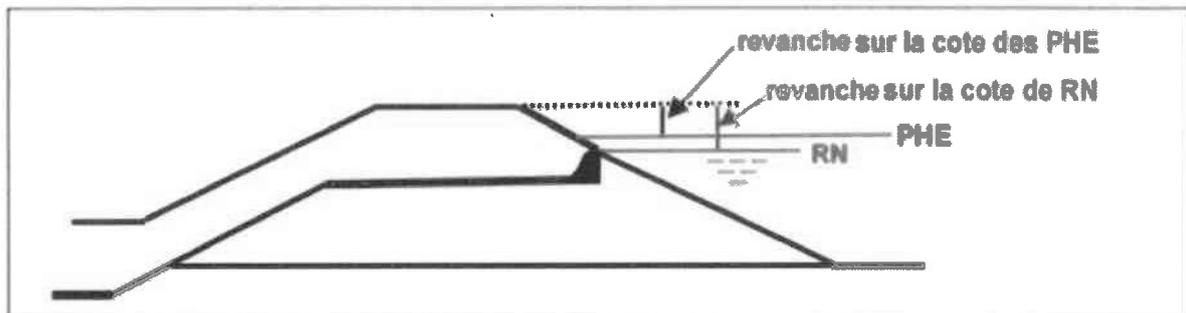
Revanche sur les PHE ou sur la RN pour un barrage
